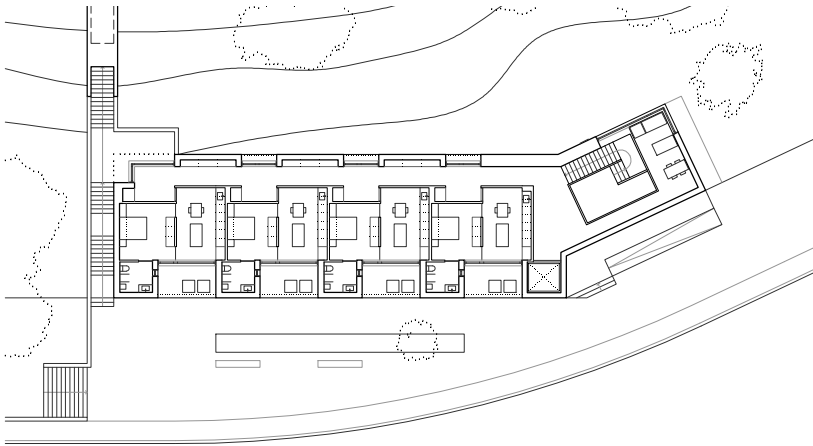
Planta primera del Módulo 1. Escala 1/500.
